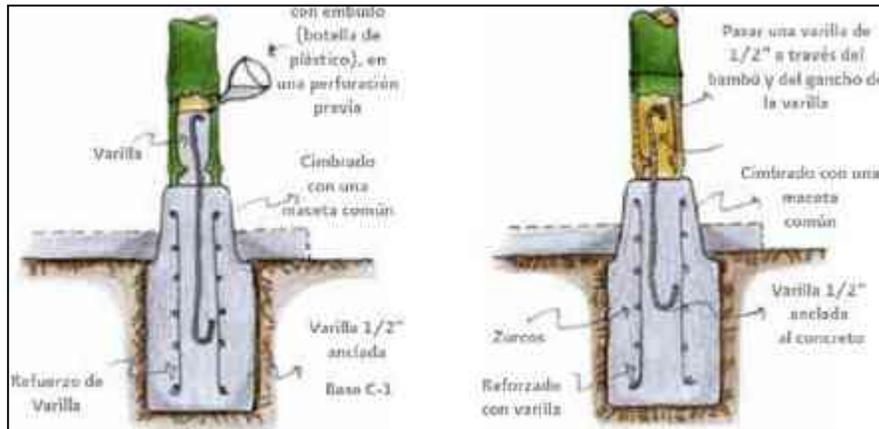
Uniones en de bambú y concreto en cimentación. Fuente: http://www.cauem.org.mx/documentiManual_para_la_Construccion_Sustentable_con_Bambu.PDF, 28/03/2014
